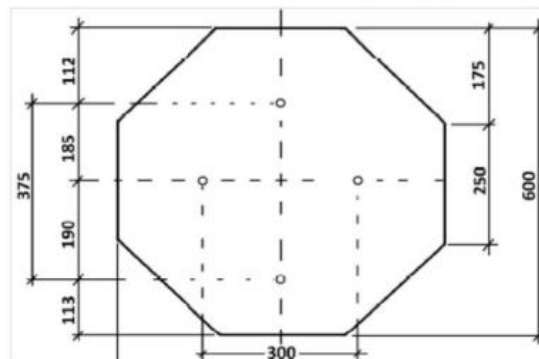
Detalhe do Dispositivo Anti-Giro e da Fundação
